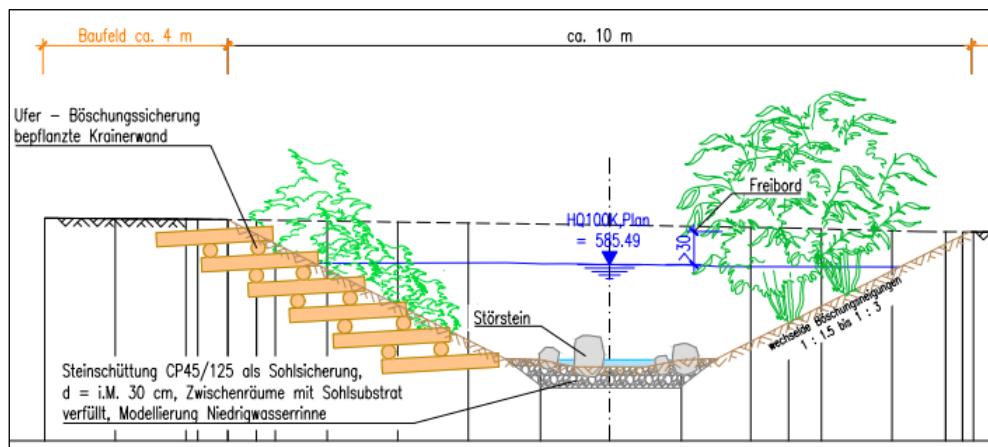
Querschnitt Wörthersbach Bereich 3.2, Planung (Quelle: IB Winkler Plan 004-1, Schnitt D-D)
